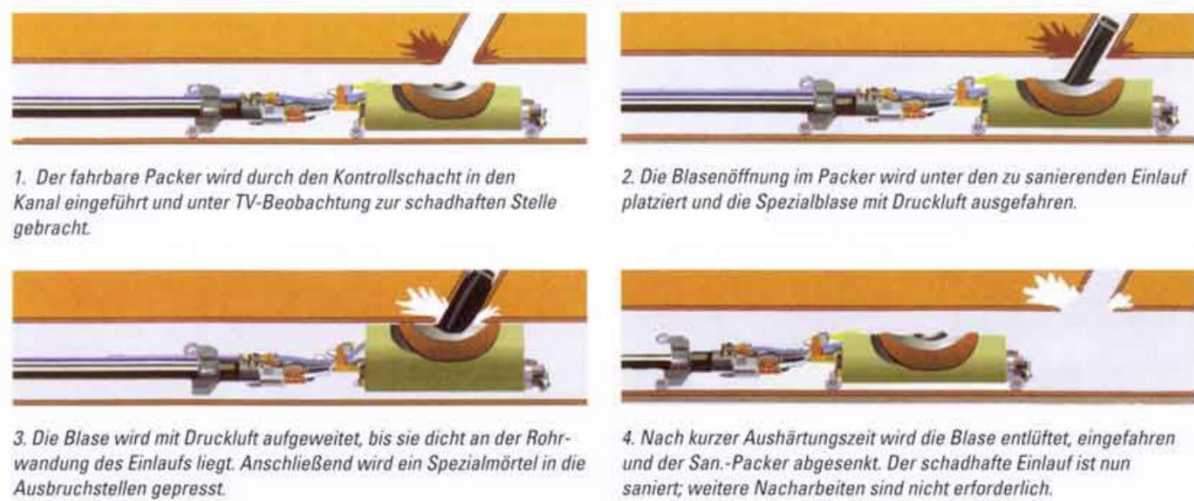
Schemadarstellung Sanierung von Anschlussbereichen mit Injektionsverfahren¹⁹⁵
